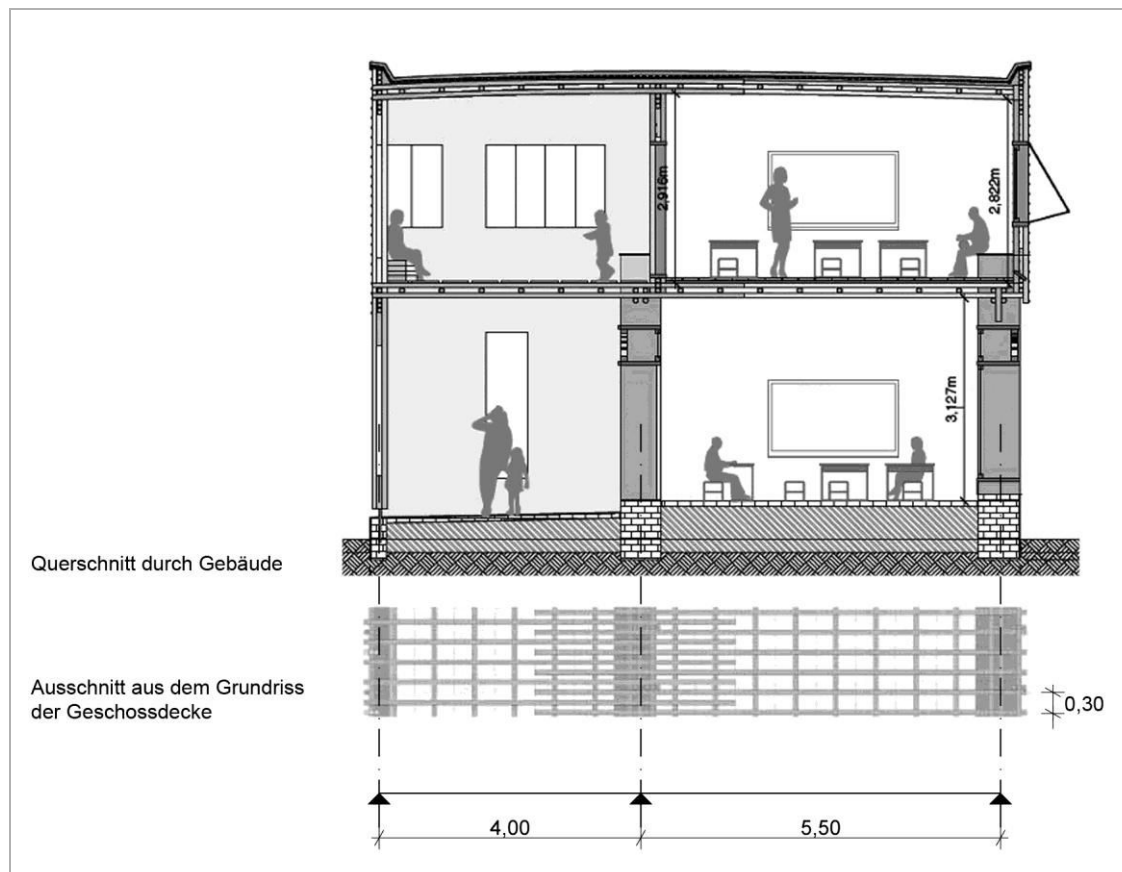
Schulgebäude Tipu-Sultan-Merkez, Pakistan. Querschnitt durch das Gebäude und Grundriss-Ausschnitt des Deckentragwerks (© Ziegert-Roswag-Seiler Architekten und Ingenieure, Berlin).
